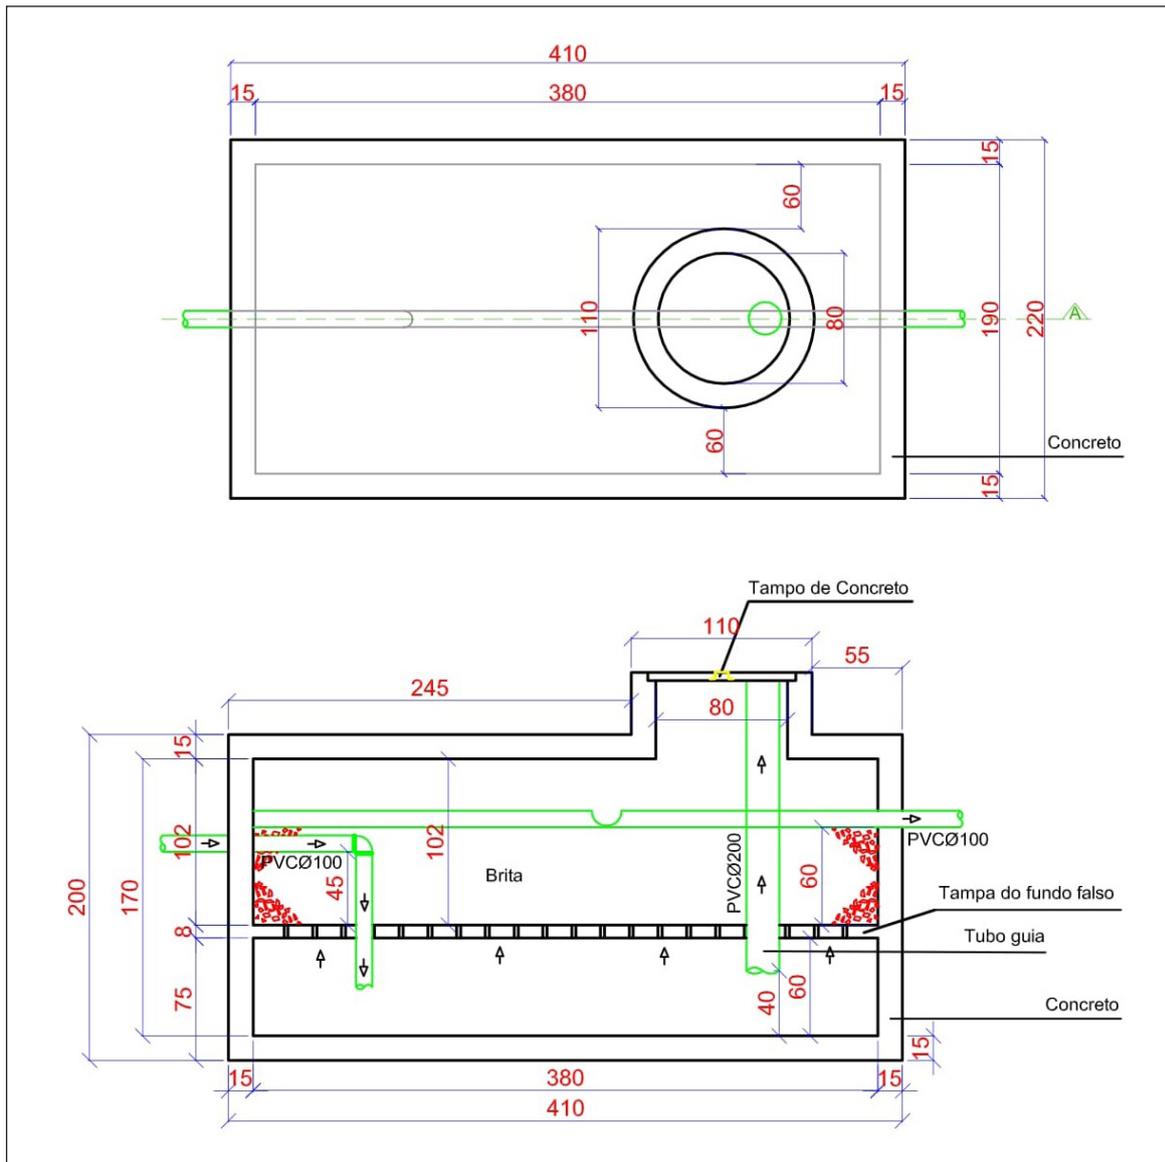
Vista en planta y corte del filtro biológico FB-01 (medidas en cm)
